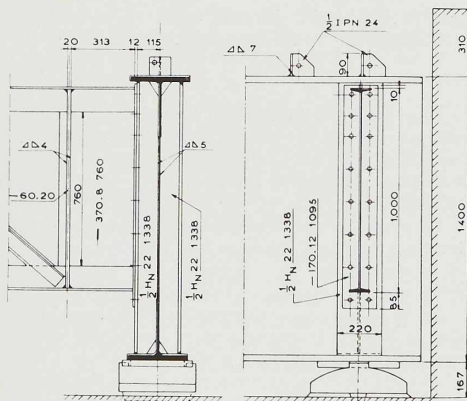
Assemblage des poutres et entretoises - culée côté appui fixe. On note l'utilisation étendue de profils à larges ailes découpés et assemblés par soudure.
